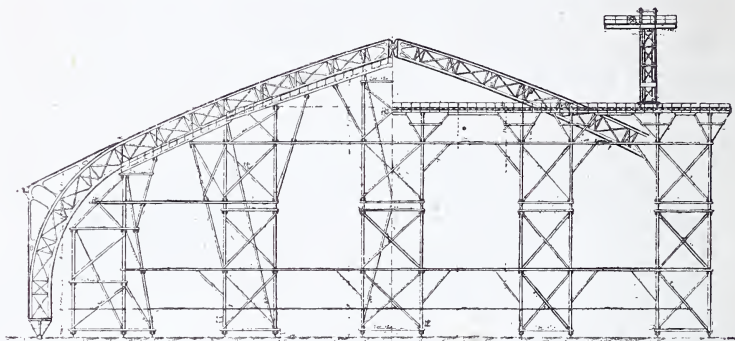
Galerie des Machines. — Montage des grandes fermes.
